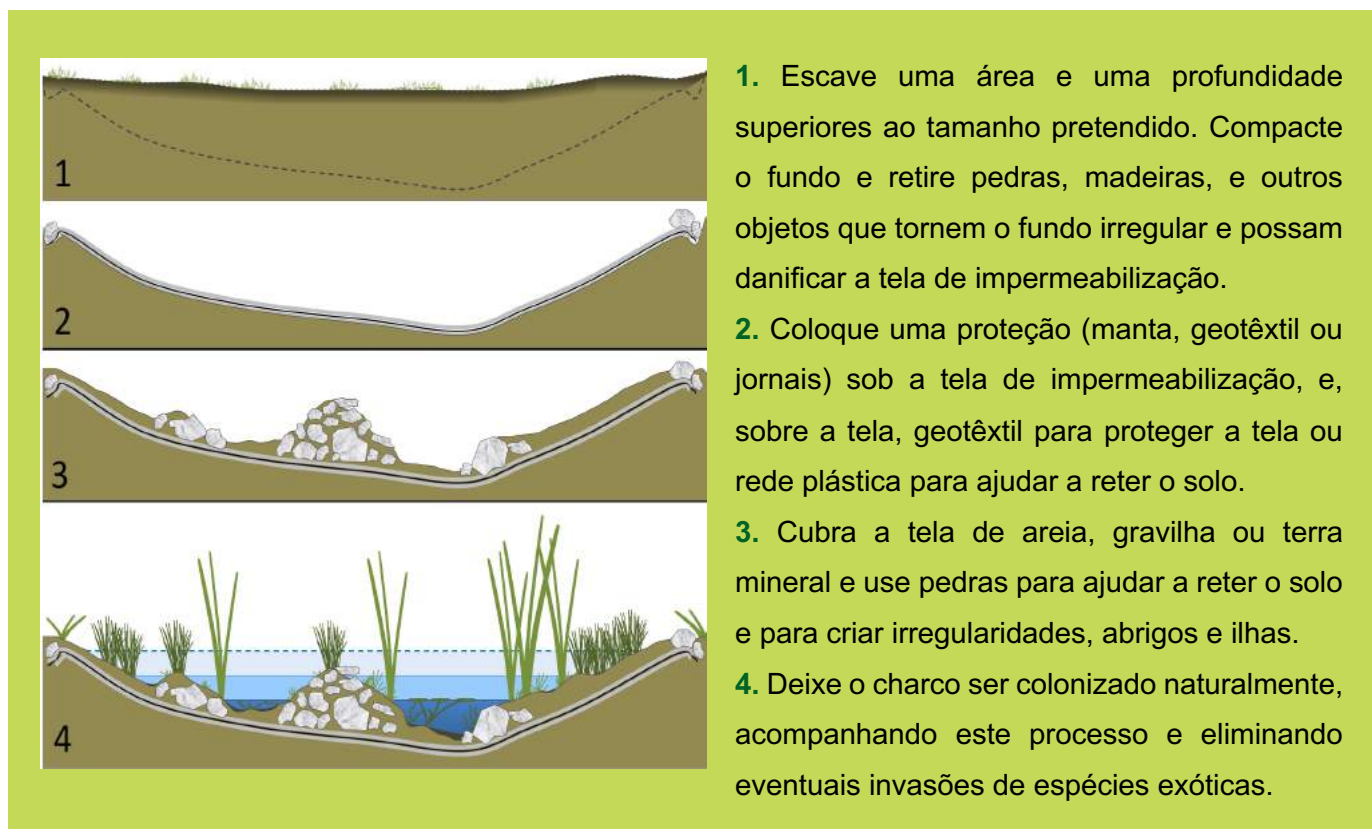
Escavação e impermeabilização de um charco sobre terreno permeável.
